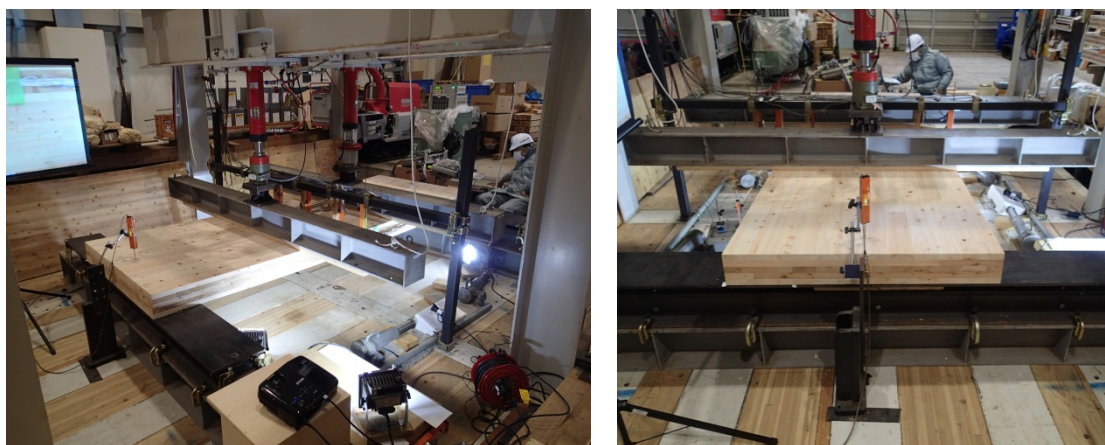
面外曲げ試験状況 (幅 1200mm)
